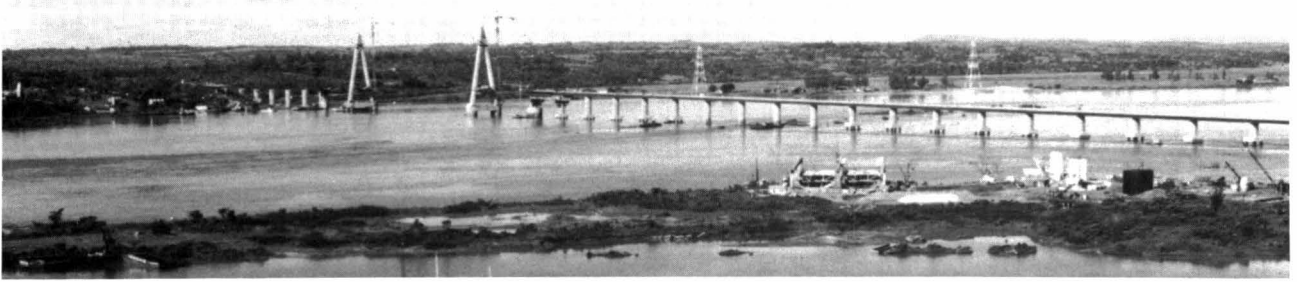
Gesamtansicht – Vue d'ensemble – General view
